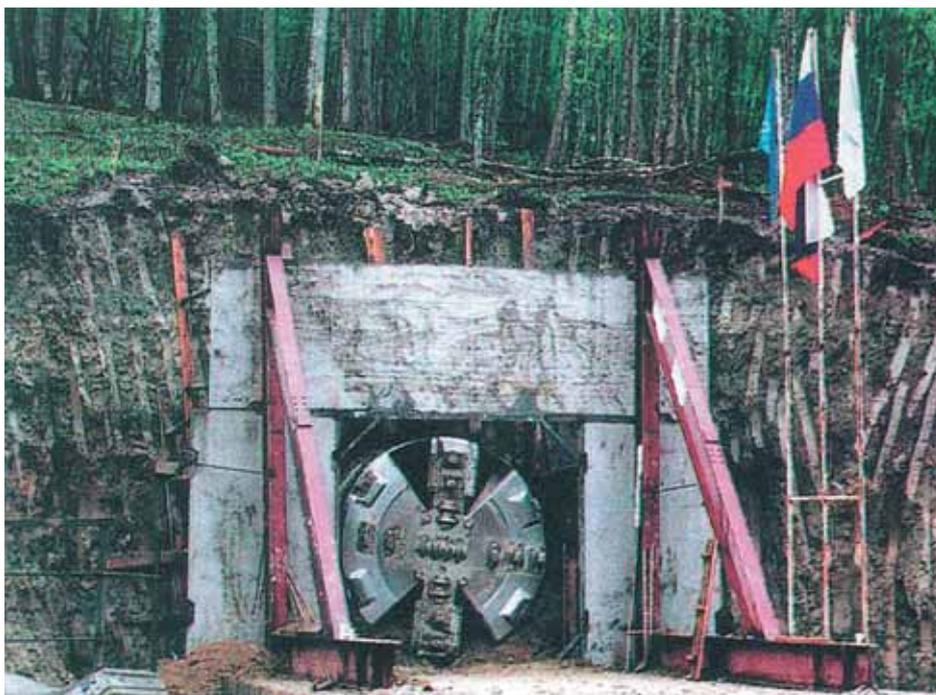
Завершение проходки тоннеля для газопровода «Голубой поток» тоннелепроходческим комплексом RMP 105SE фирмы «Lovat»
